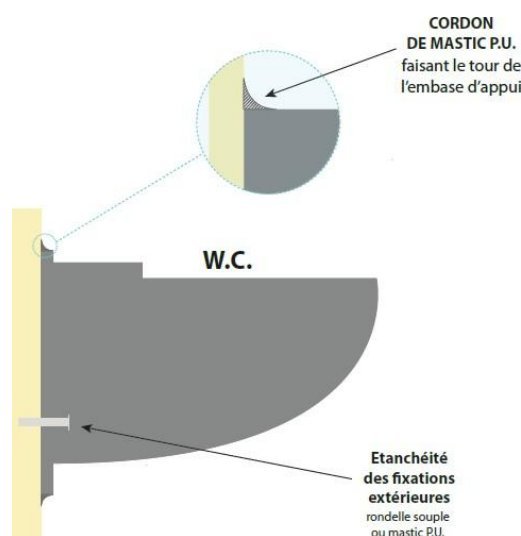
Etanchéité des fixations murales (cuvette WC)
